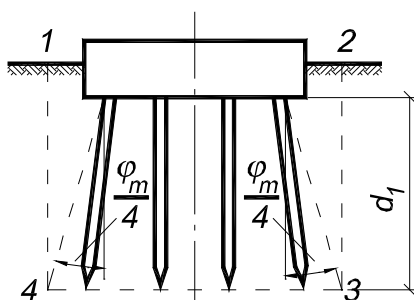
Умовний пальовий фундамент з ростверком, заглибленим в ґрунт при куті нахилу паль менше, ніж $\varphi_m / 4$
